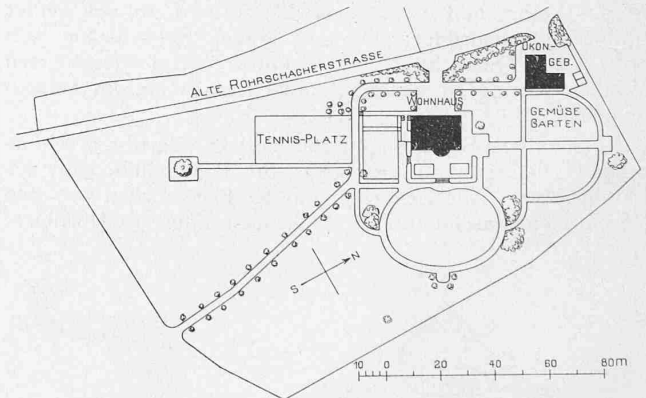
Lageplan des Landhauses «Oberziel». — 1 : 2500.
